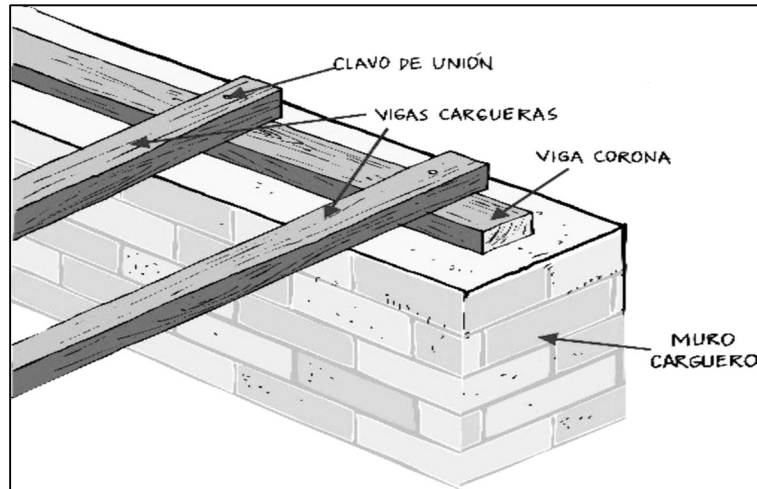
Viga corona con vigas de carga. (Fuente: Yamin et al; 2007: 294)
